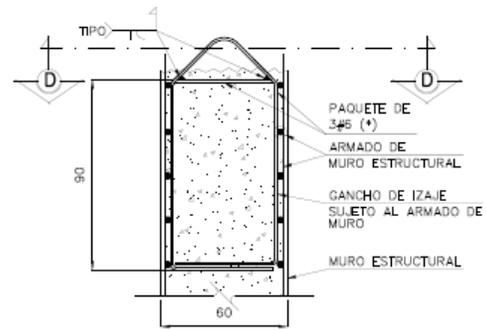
Detalle de ganchos de izaje para muro estructural en colados subsiguientes.
